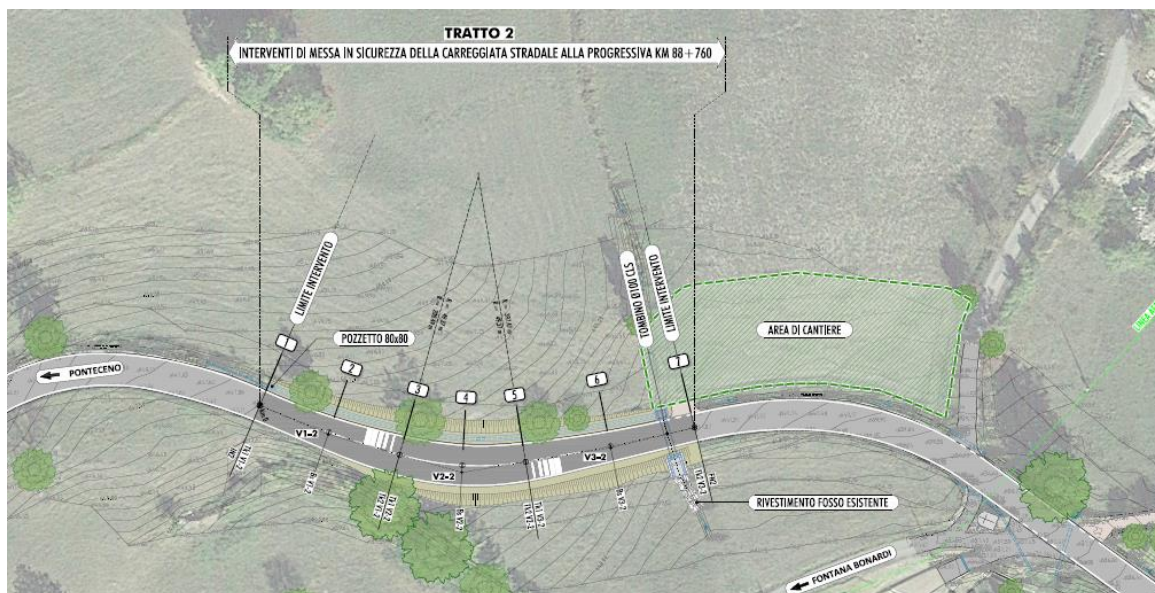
INTERVENTO TRATTO 2 – STRALCIO PLANIMETRICO
